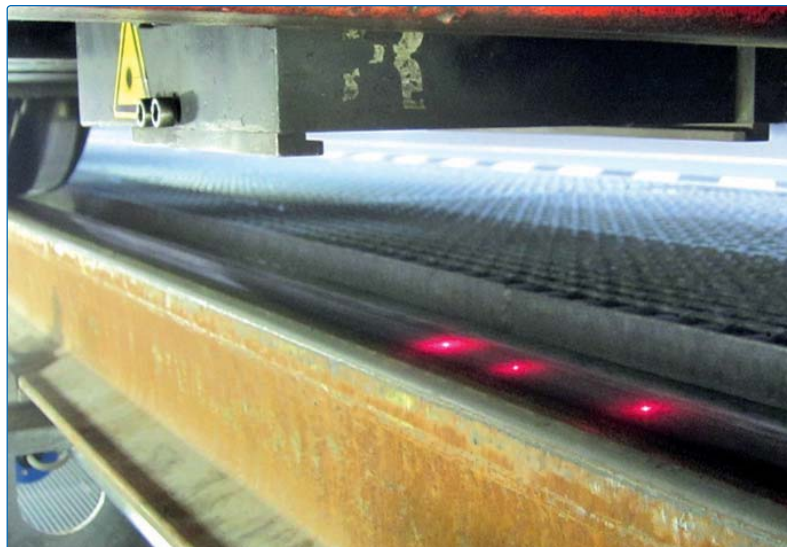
Misurazione del profilo longitudinale della rotaia
